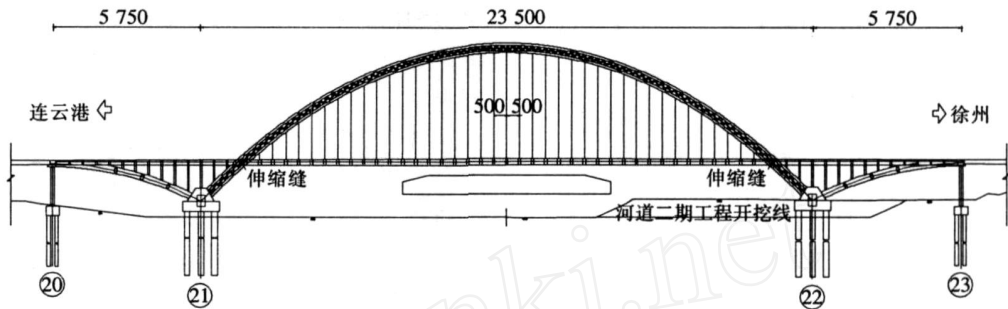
京杭运河大桥主桥布置立面图(单位:cm)
